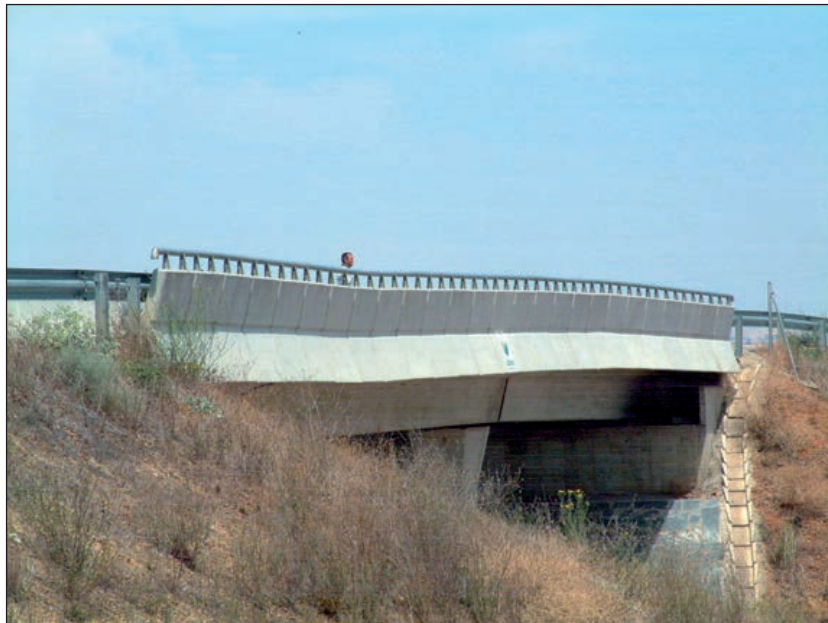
DEFORMACIÓN EXCESIVA DE UN TABLERO DE VIGAS ARTESA. SE DETECTA PERFECTAMENTE OBSERVANDO LA FALTA DE ALINEACIÓN DEL PRETIL.
